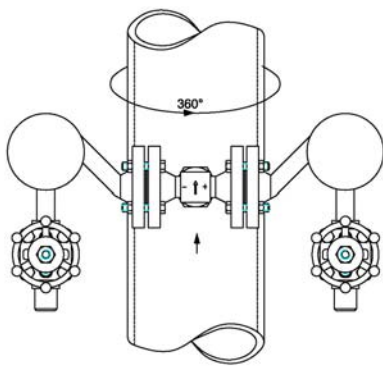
Installation in einer vertikalen Rohrleitung Typ: IBFD-25...-K1H-A81
